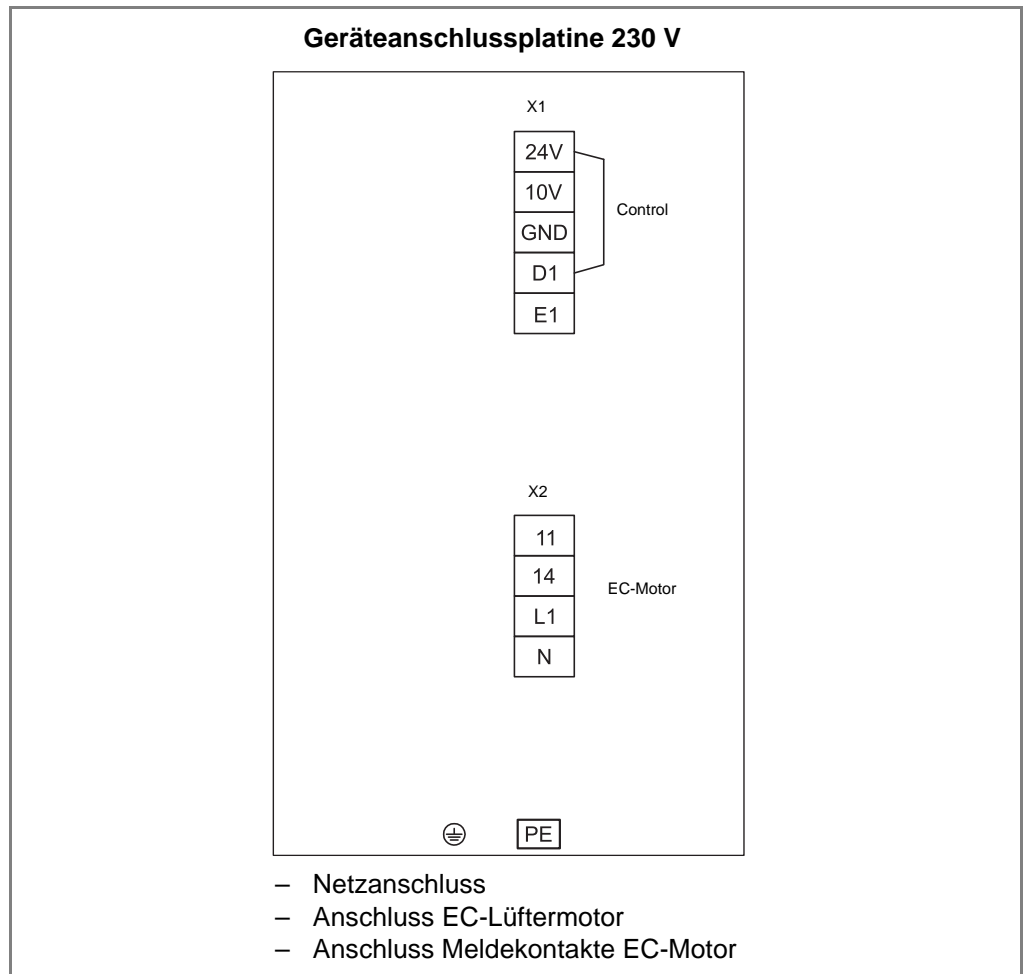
Geräteanschlussplatinen des Gerätes mit EC-Motor 230 V
